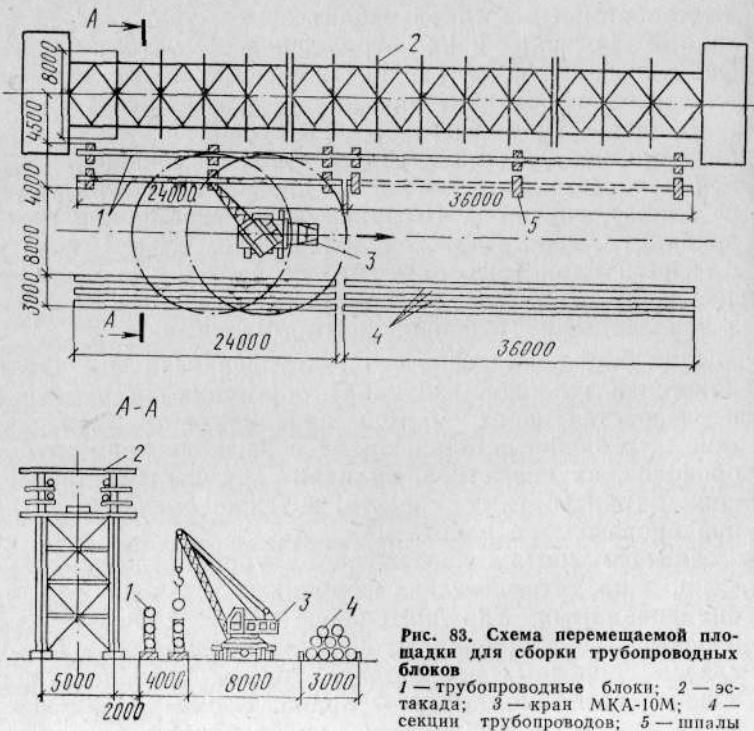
Схема передвижной площадки для сборки трубопроводных блоков
